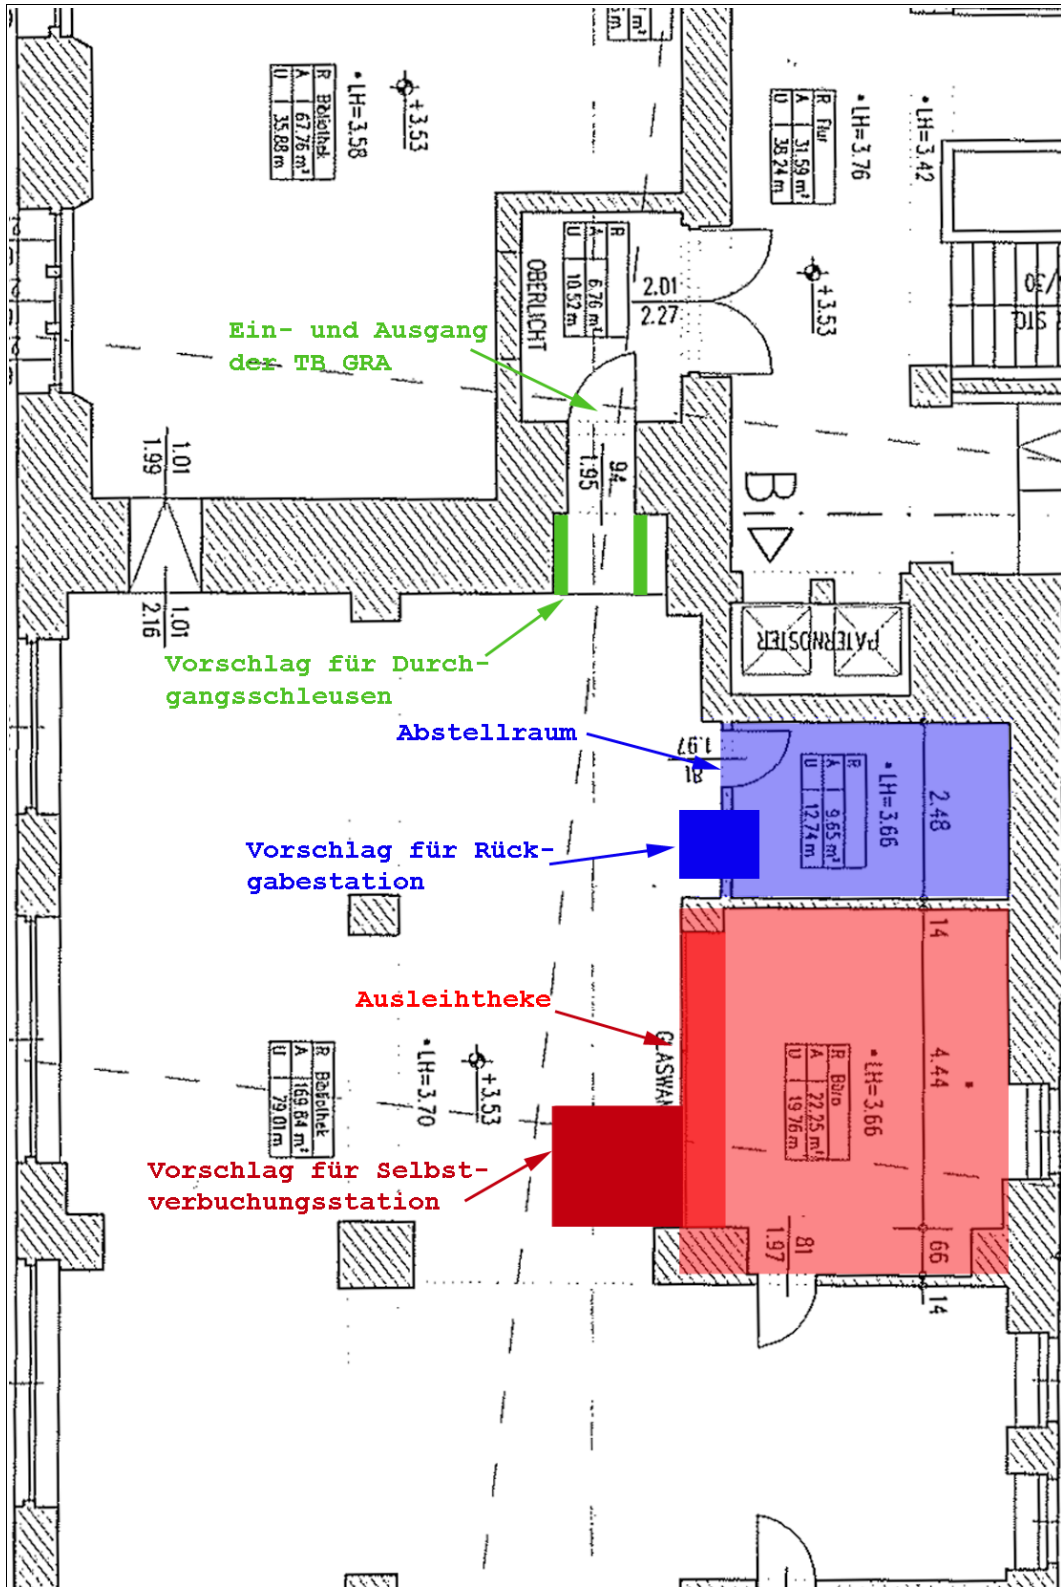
Ausschnitt aus dem Grundriss der TB GRA
